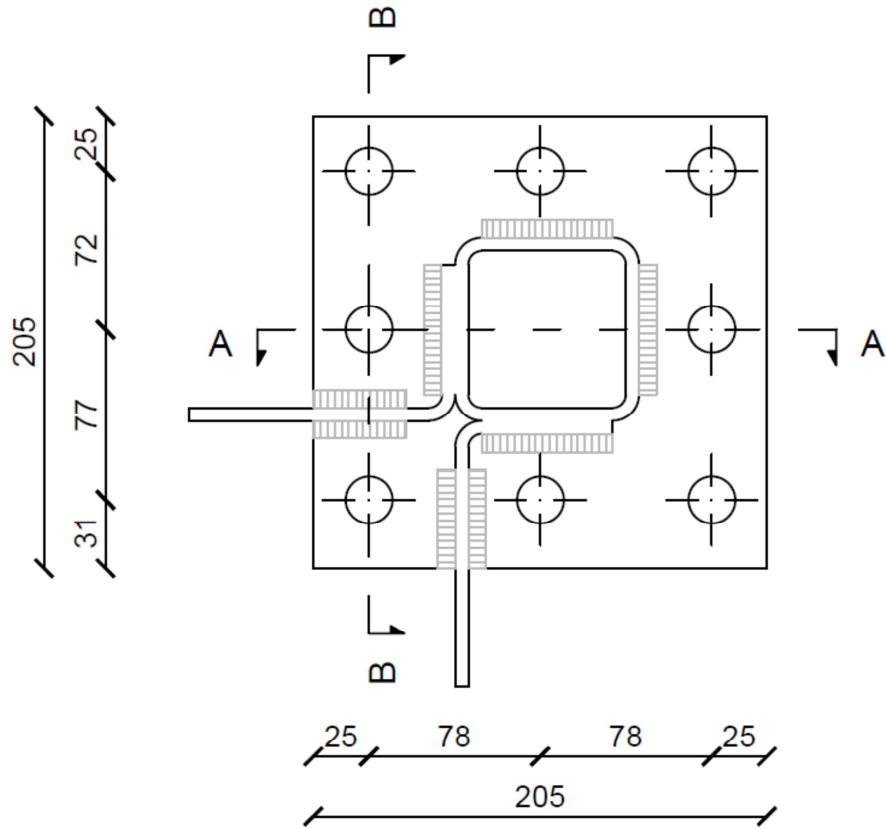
Vista in pianta del collegamento di continuità dei montanti ad L
